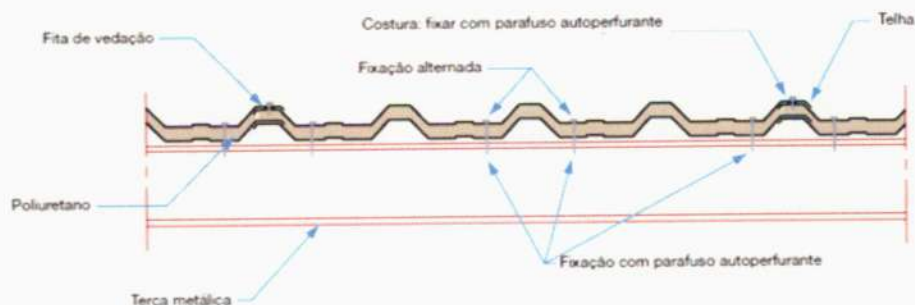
Montagem da telha Trapezoidal com Poliuretano (Fonte: ABCEM, 2009)
